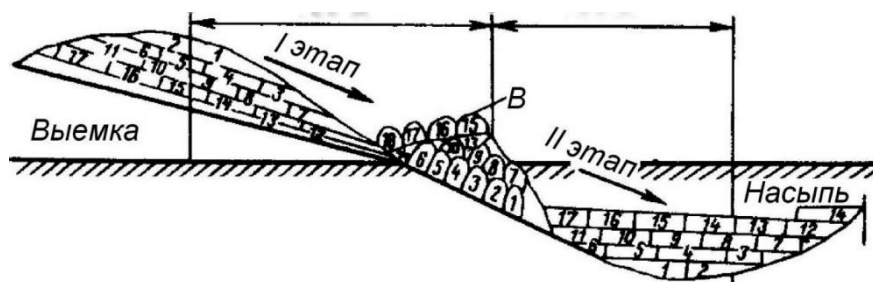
Схема способа перемещения грунта в два этапа
